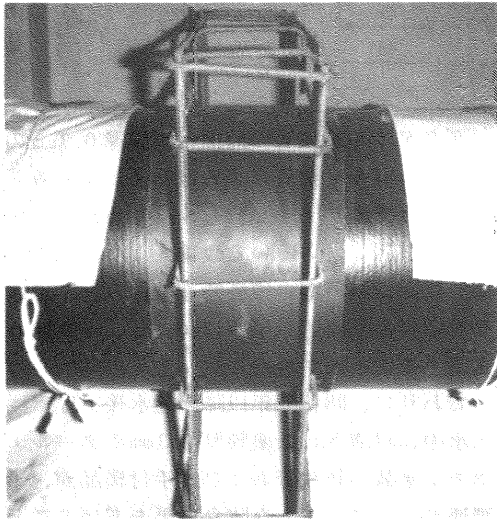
鉄筋組立ておよびゴム製平パッキン取付け状況
